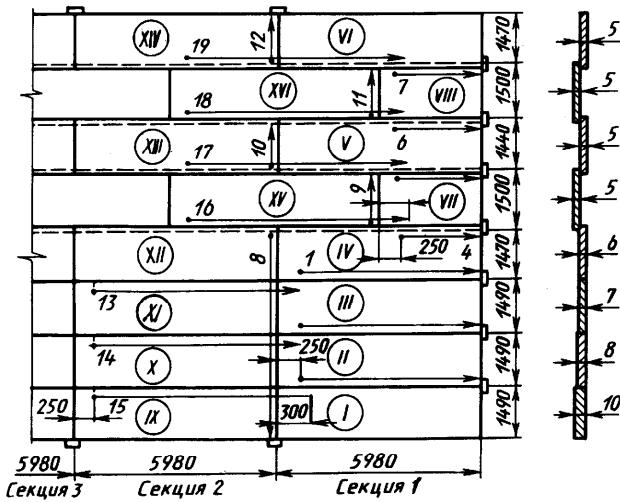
Последовательность сборки и сварки стенки резервуара (5000 м³)
